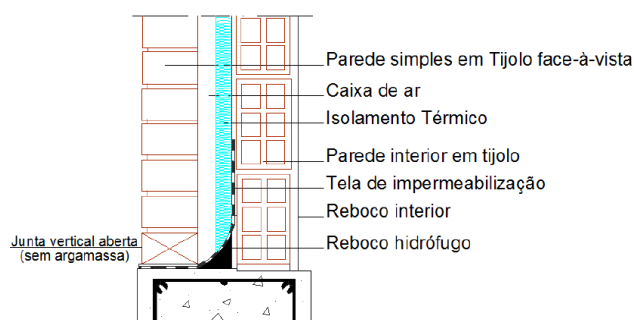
Corte da zona da caleira para escoamento de uma parede dupla de tijolo com face à vista [49]
